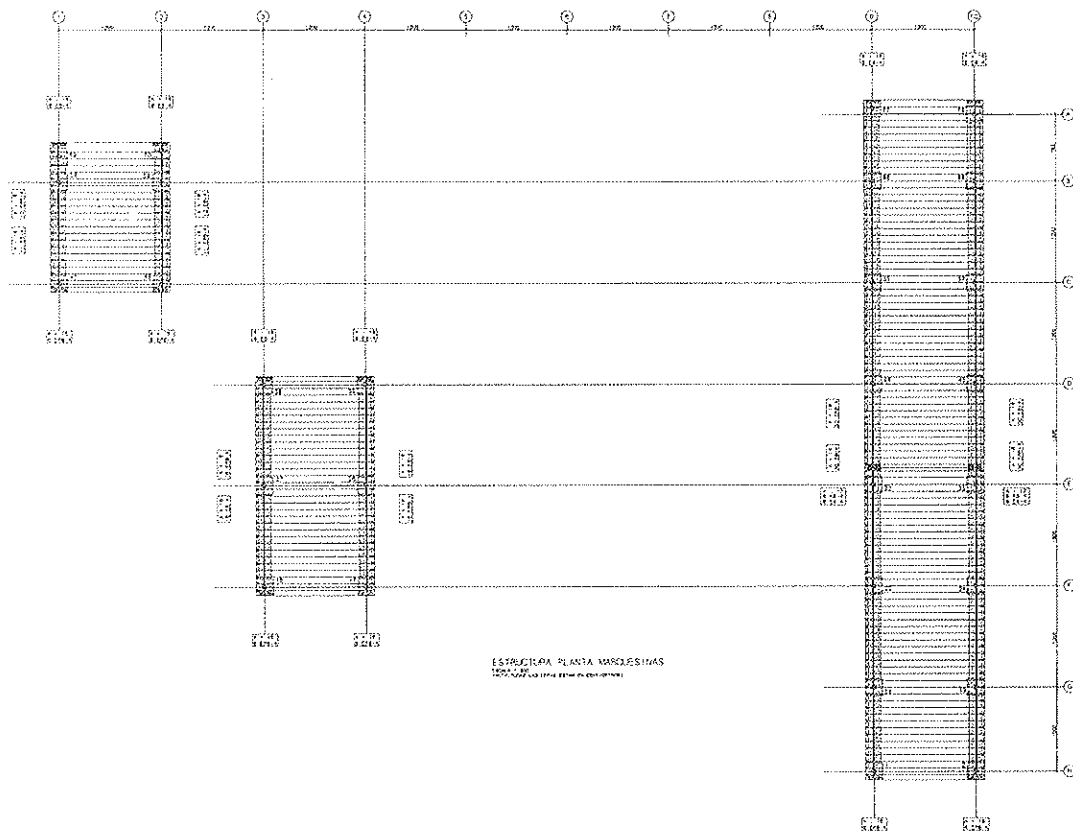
Distribución e planta de los tendones de pretensado en cubierta.
